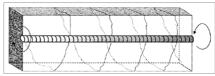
Fisuras por Torsión Fuente: Investigación
